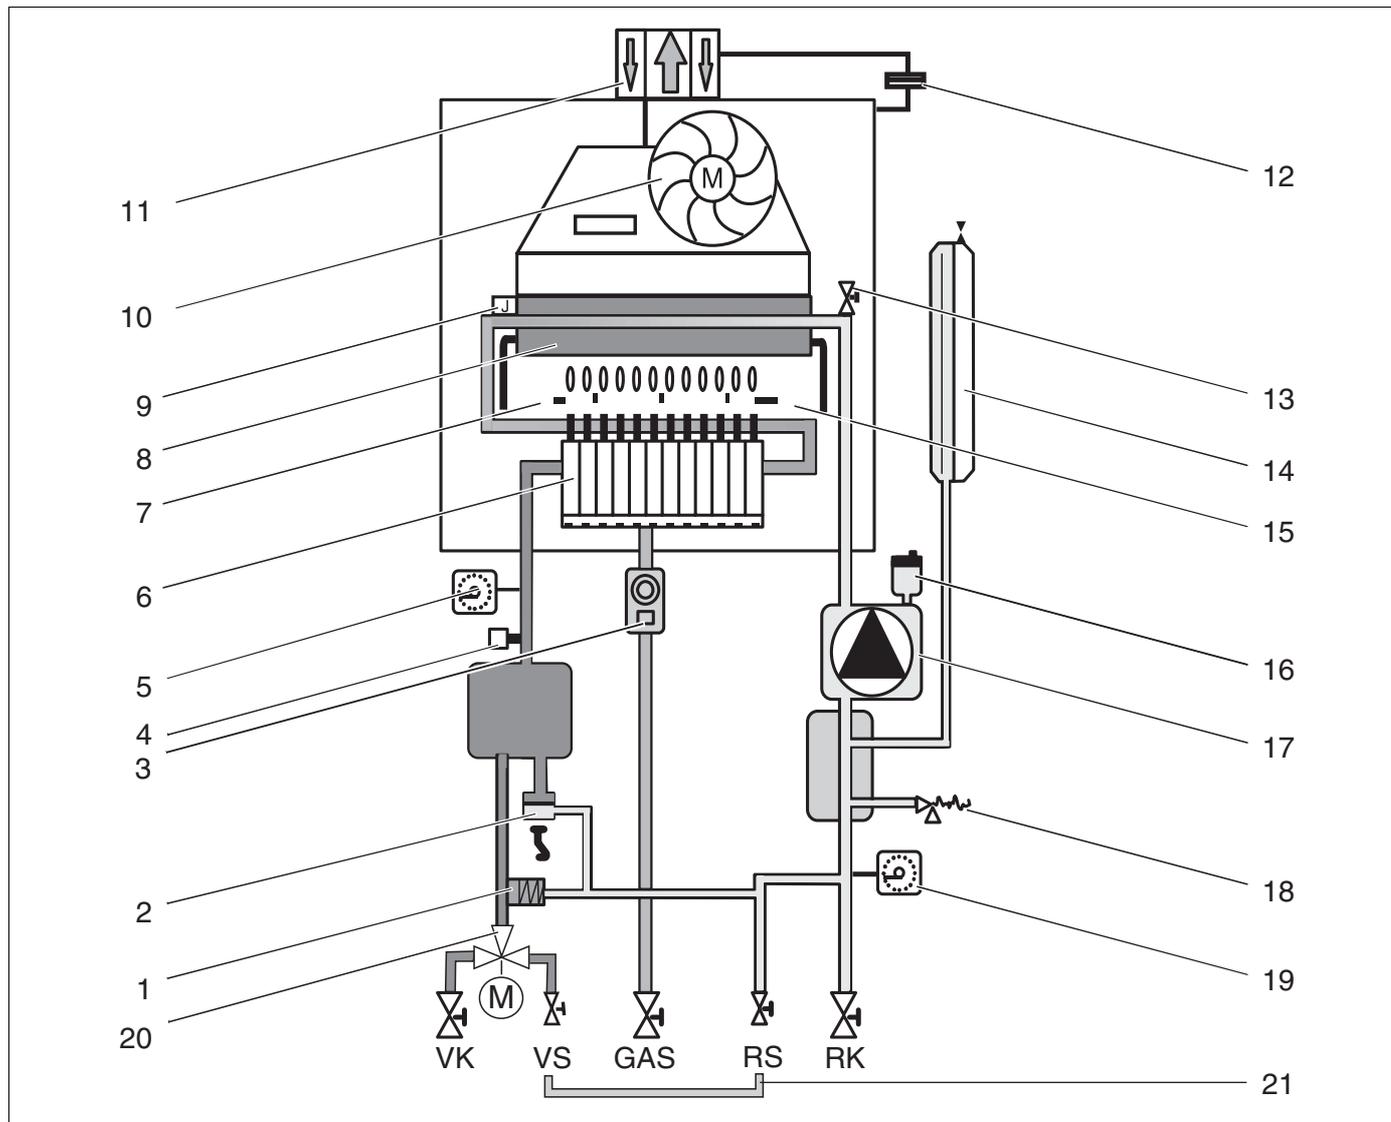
Funktionsschema HG 12 WG -24 mit Dreiwegeventil
